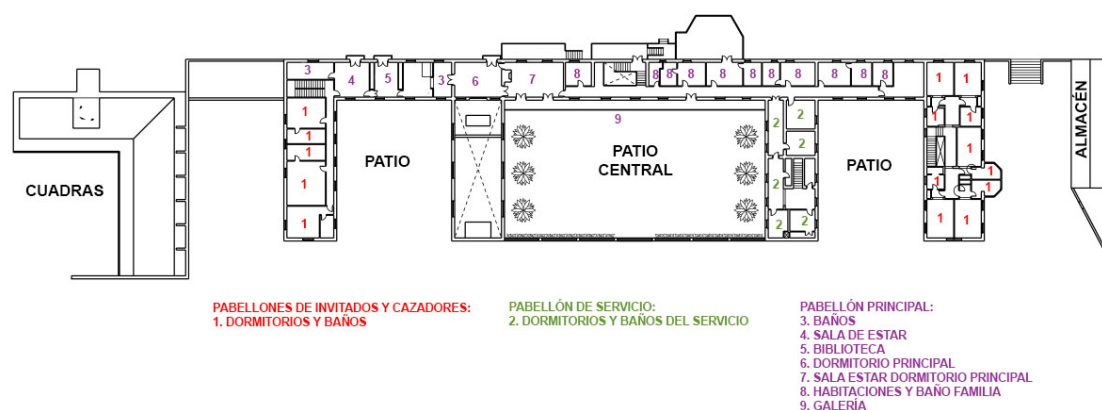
Plano planta alta de la casa de la Finca La Alcaría. Fuente: Elaboración propia en base a plano de AAVV (2002).
